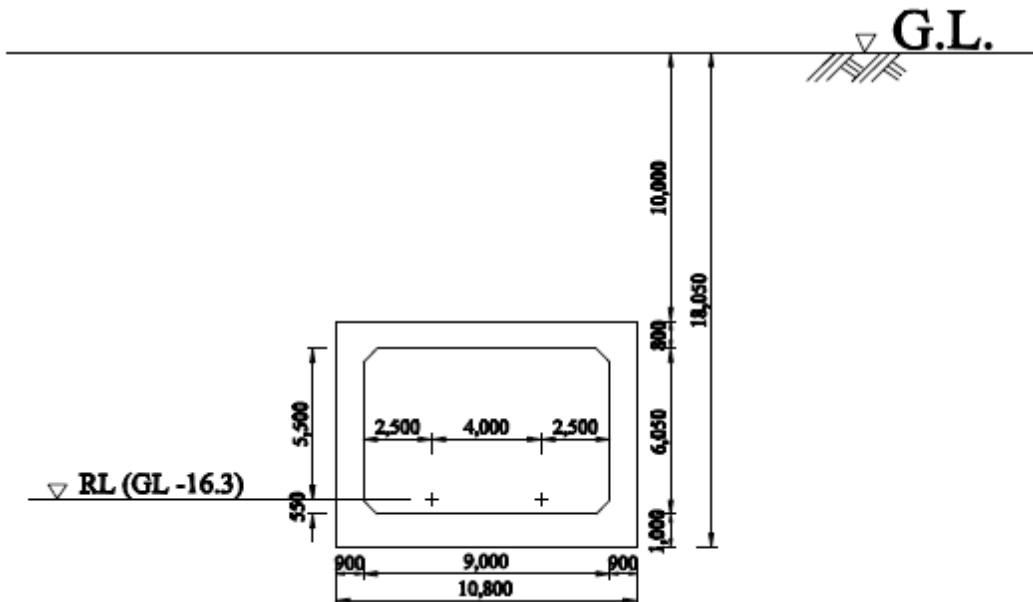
Notun Bazar 駅 Plan and Cross Sections
